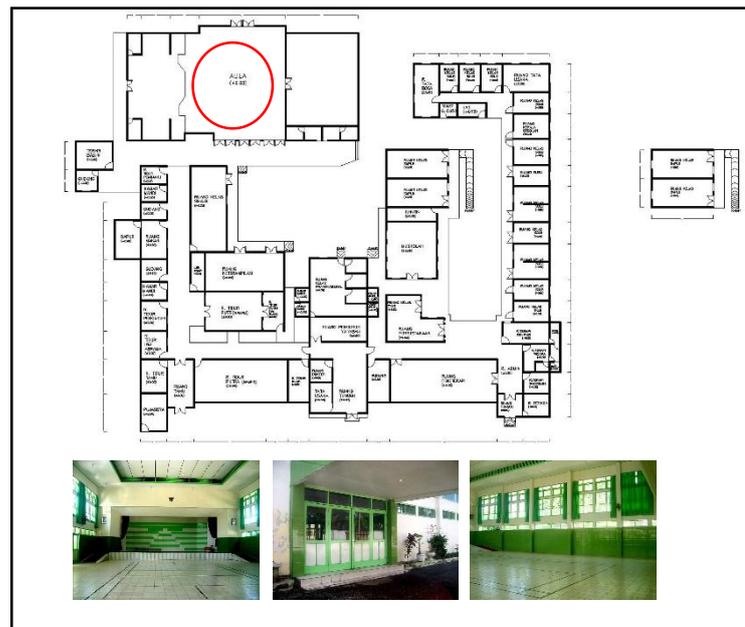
Denah eksisting dan foto eksisting area asrama YPAC Malang
